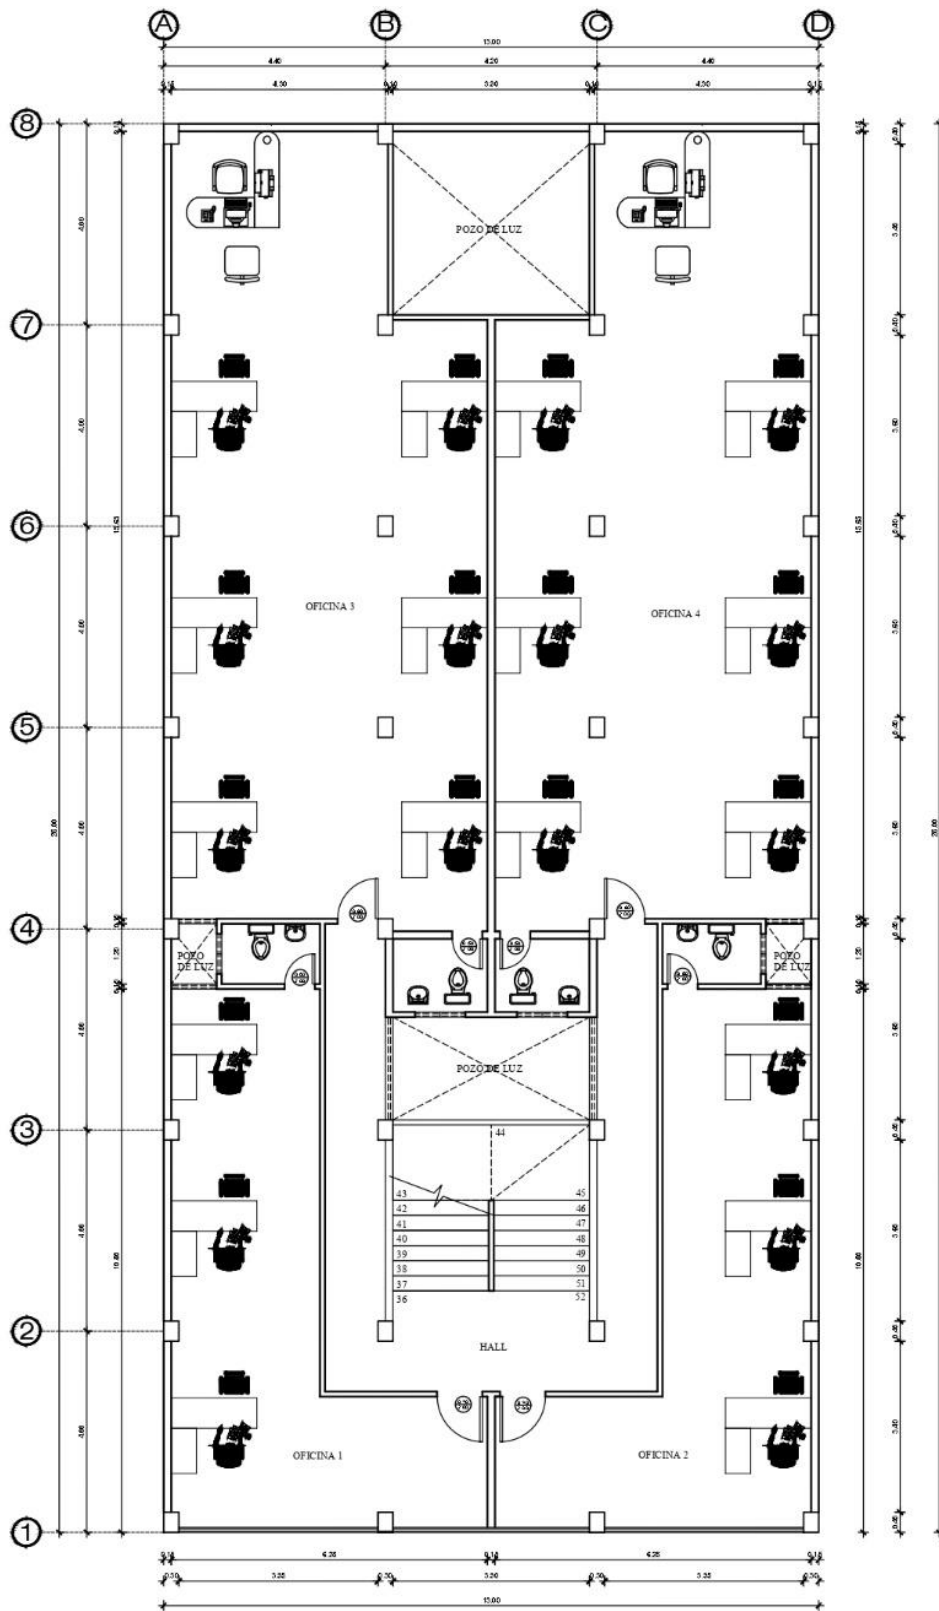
Planta arquitectónica oficina (Autores)
